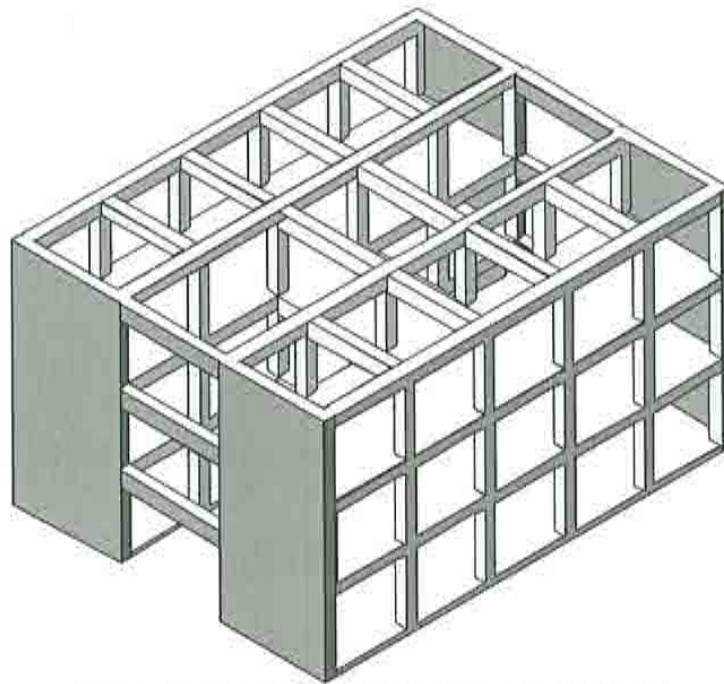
MUROS ESTRUCTURALES EN LA PERIFERIA
